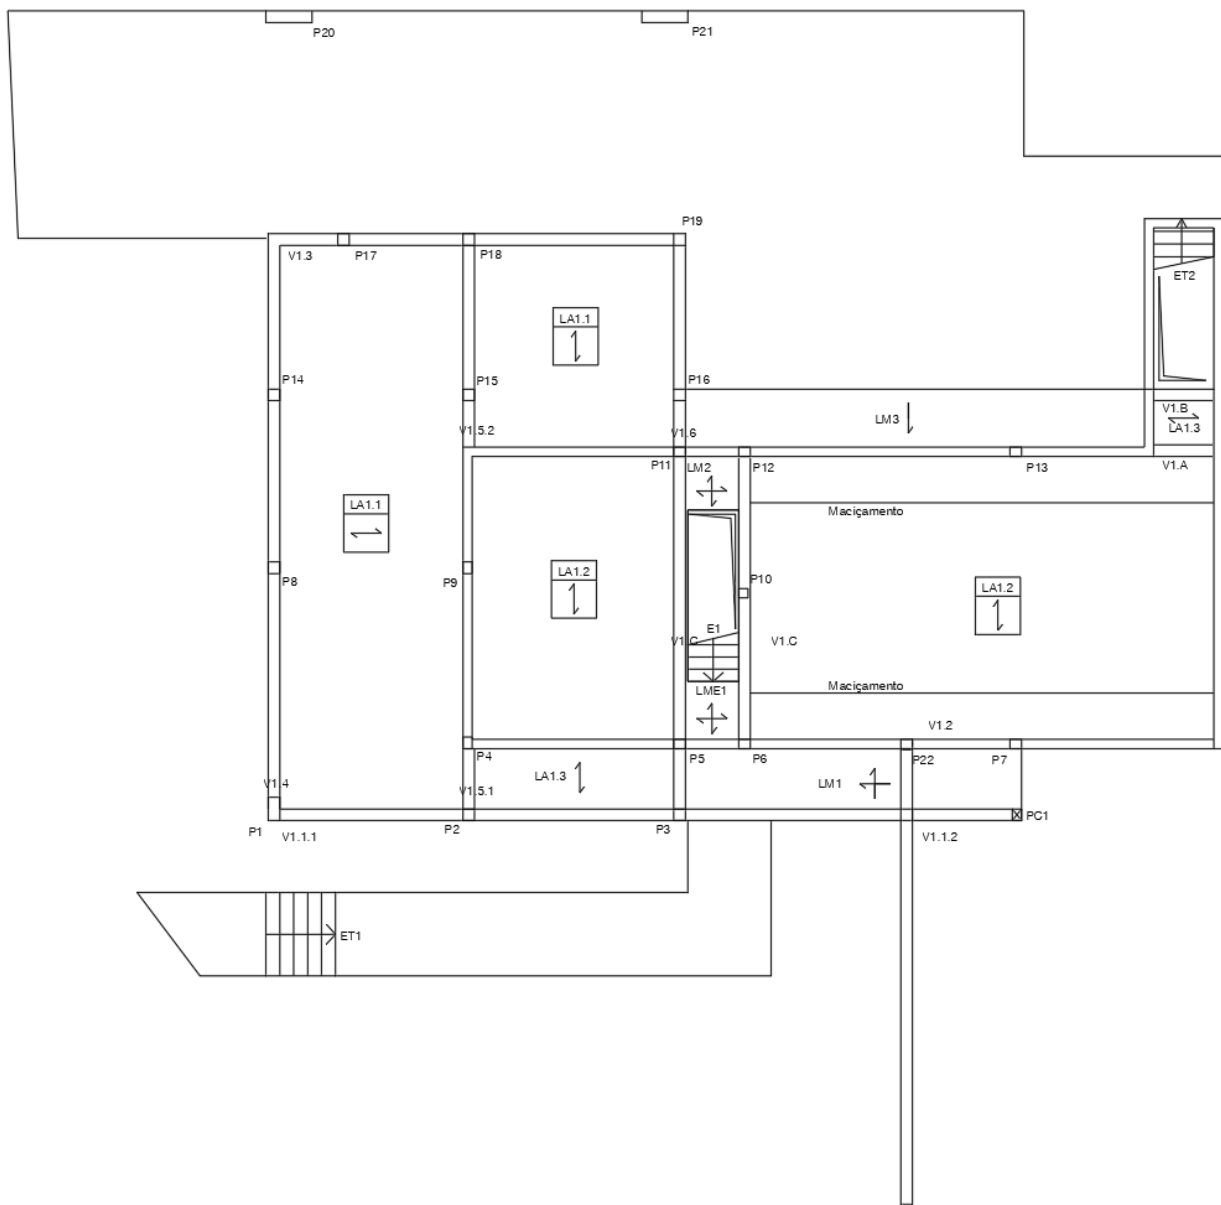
Esquema estrutural do R/C (Projeto de estruturas).
